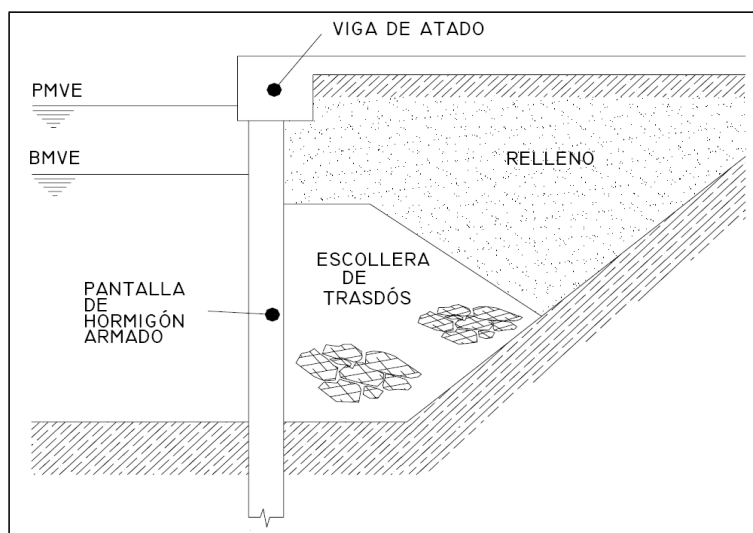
Sección tipo de un muelle con pantalla contigua de hormigón armado
